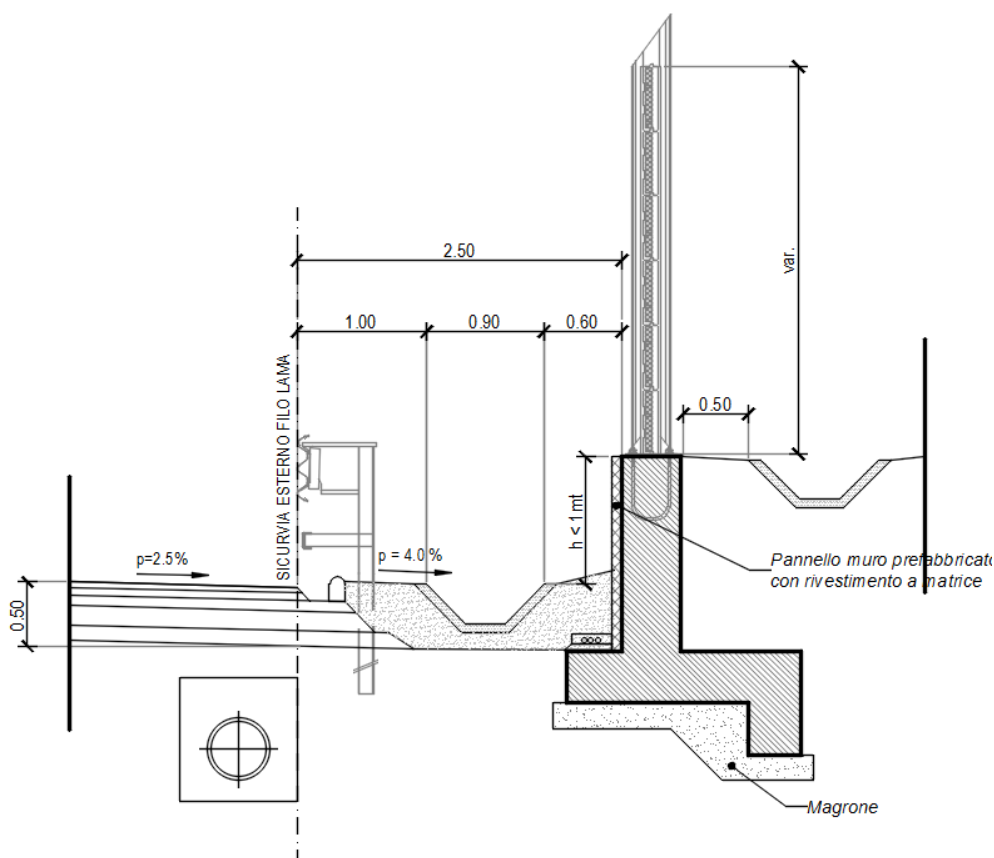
Sezione trasversale del muro di fondazione per barriera fonoassorbente in trincea (TIPO 1).
